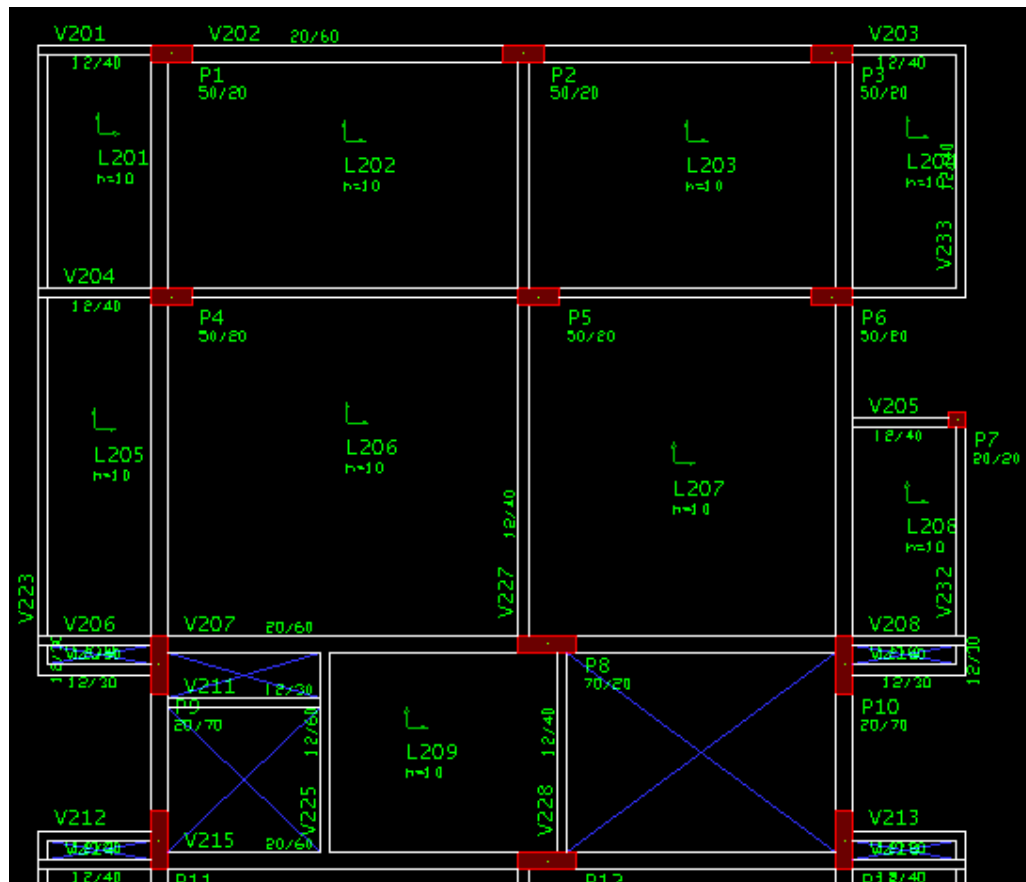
Planta de formas pavimento tipo (obs.: o pavimento é simétrico, dimensões da outra metade são iguais às da primeira) (Fonte: Autor)
